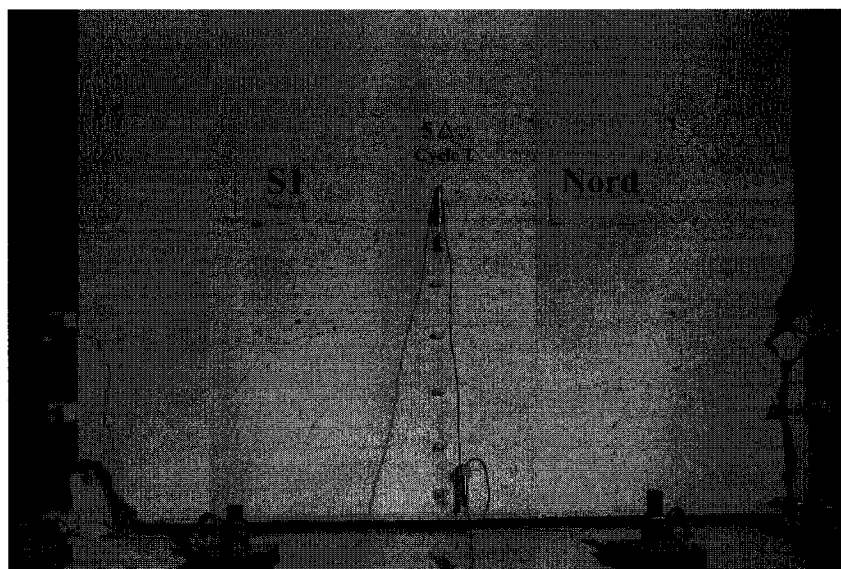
Photo de la face nord de S1 à la fin de l'essai (Boucher-Proulx, 2008)
